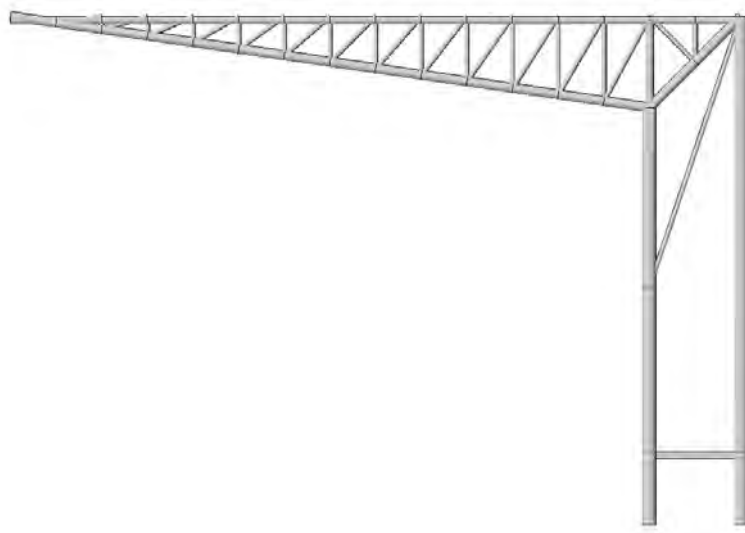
Modulo trasversale con la trave reticolare a sbalzo
